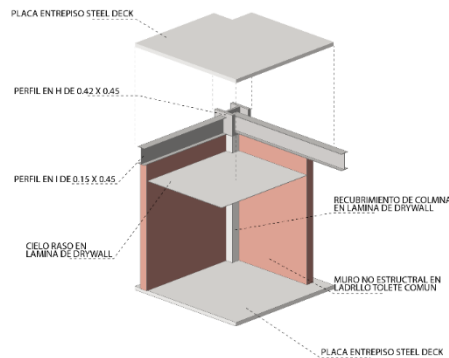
Detalles Constructivos placa entre piso y cielo raso.
